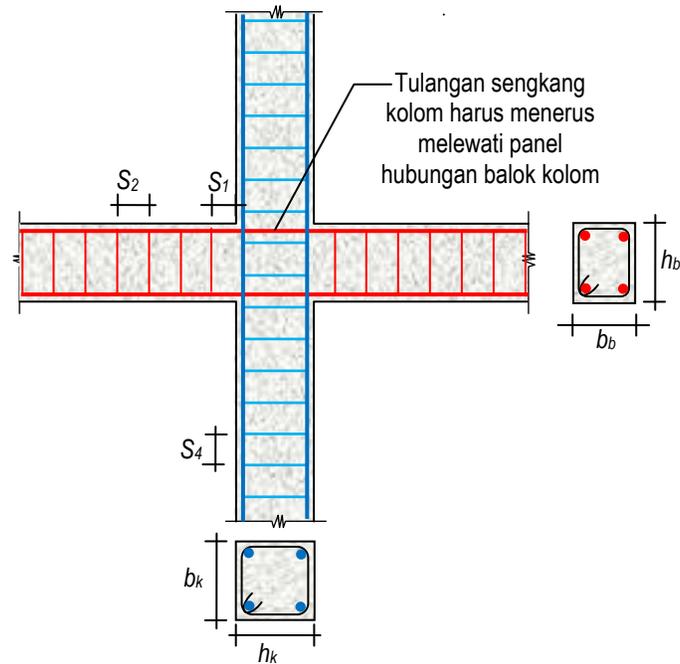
Detail Penulangan Hubungan Balok Lantai dengan Kolom Pinggir.
